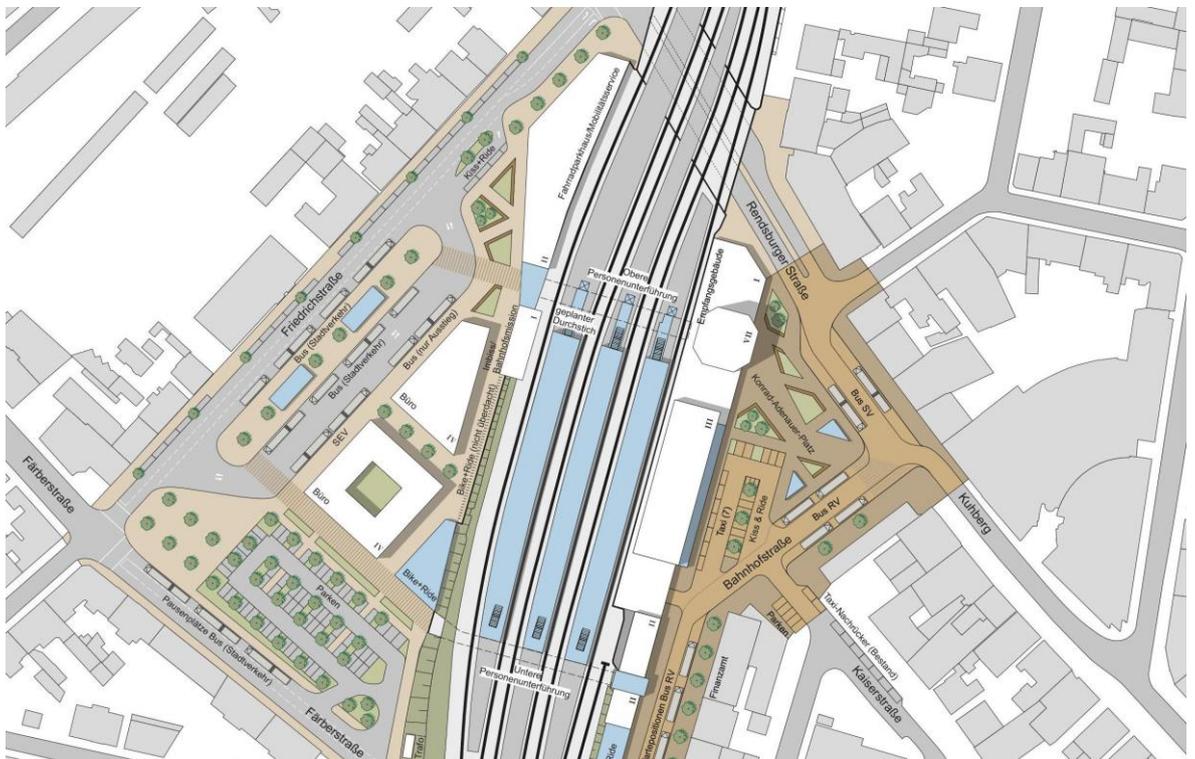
Ausschnitt des Lageplans II A - Ersatz Postgebäude / Erhalt Parkplatz
